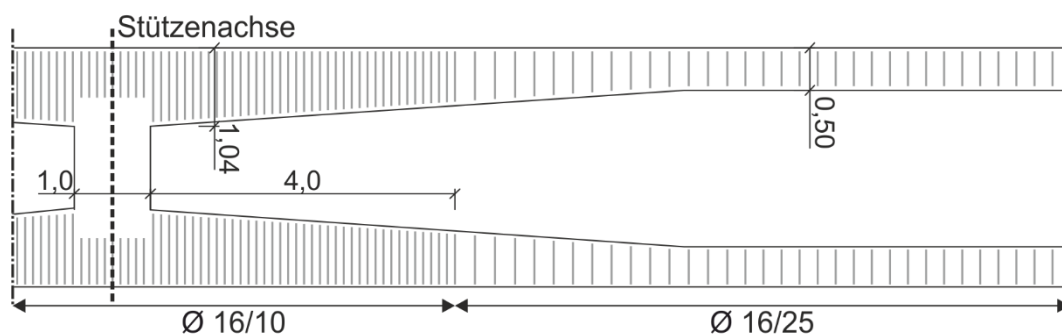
Querkraftbewehrung der Brücke A (Draufsicht)
